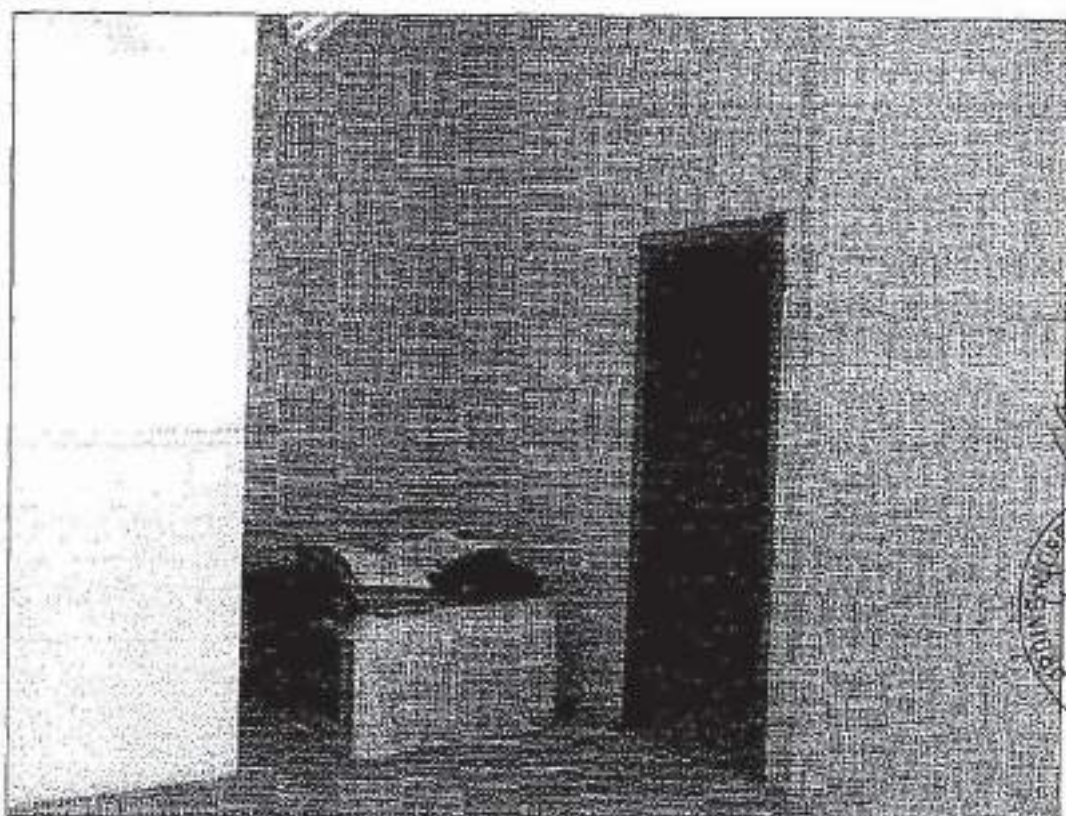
Vista interna del lotto n. 8. Magazzini al piano terra prospicienti via del Turismo.
